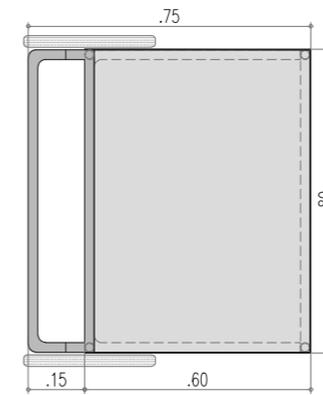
Planta puesto de venta semi-estacionario tipo 3. Esc 1:20
